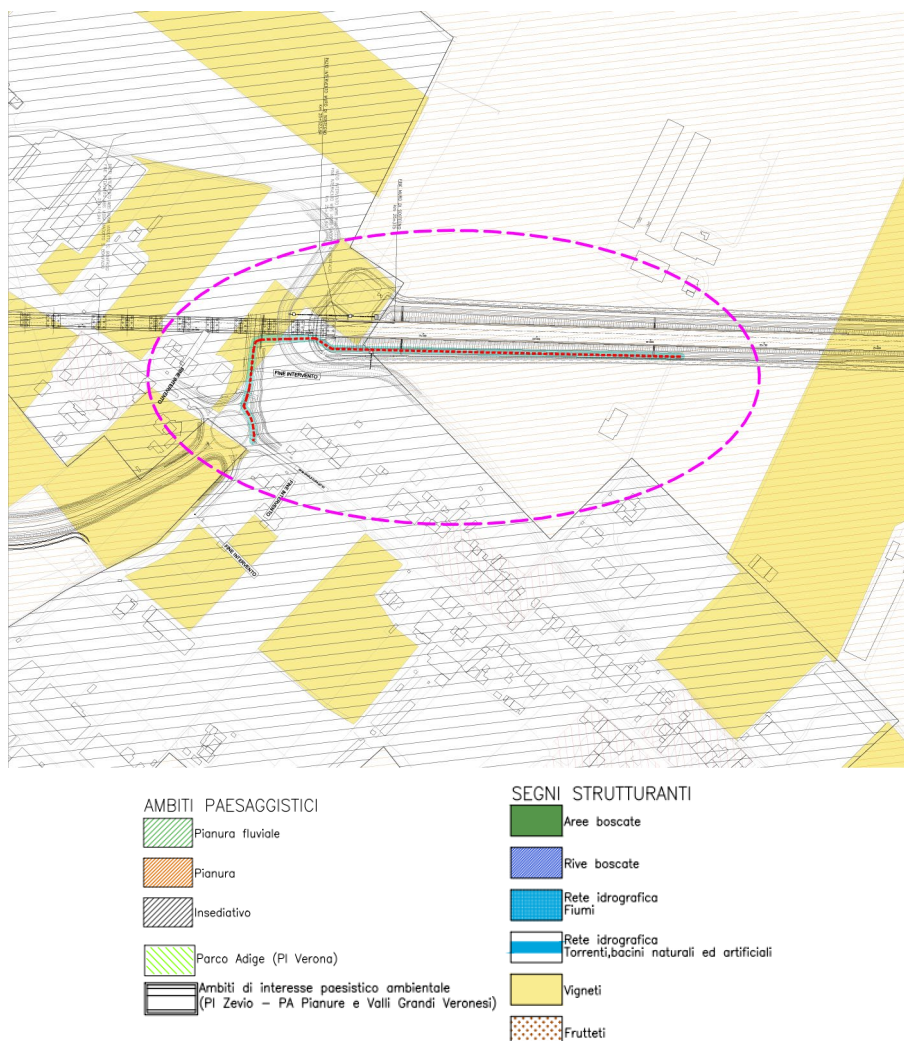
Stralcio Carta del paesaggio Tav.1/7, con individuazione delle aree interessate dalle varianti.
